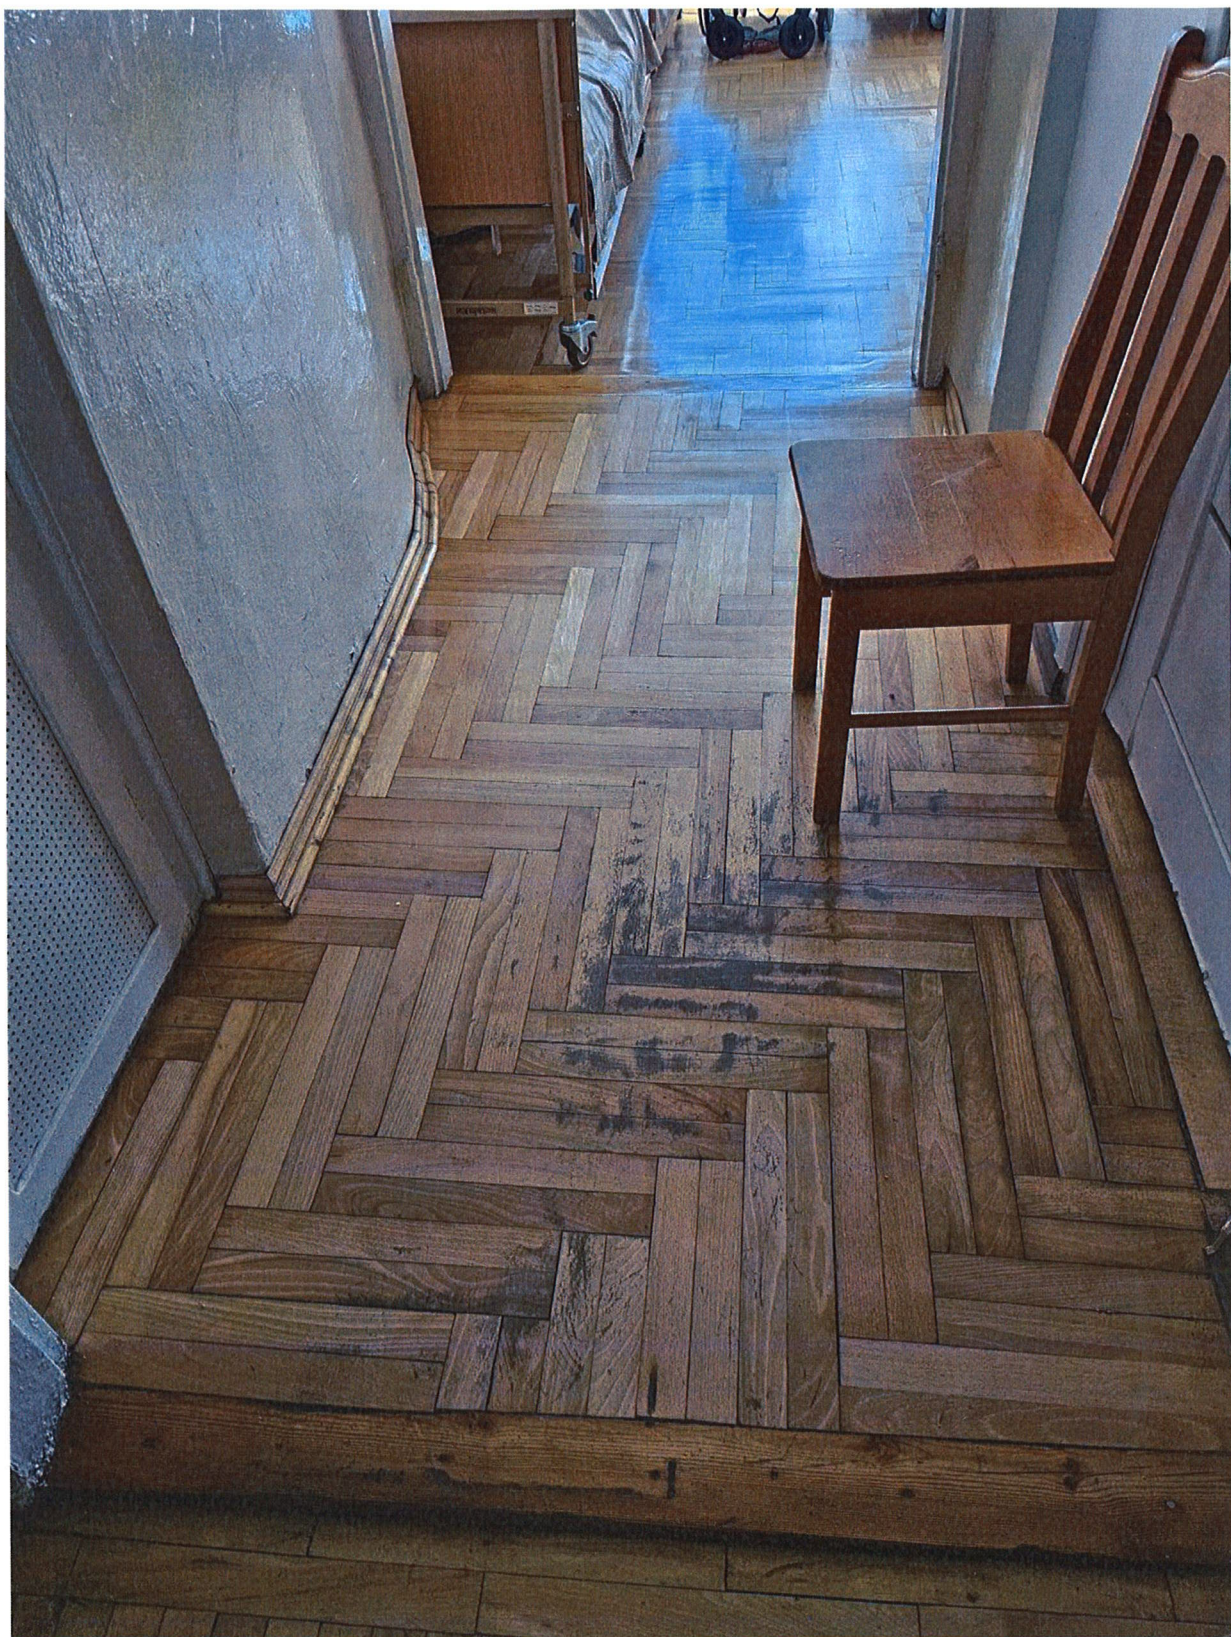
Pałac Badenich w Bejskach. Piętro pałacu. Widoczne rozległe zniszczenia stolarki drzwiowej i parkietów.
